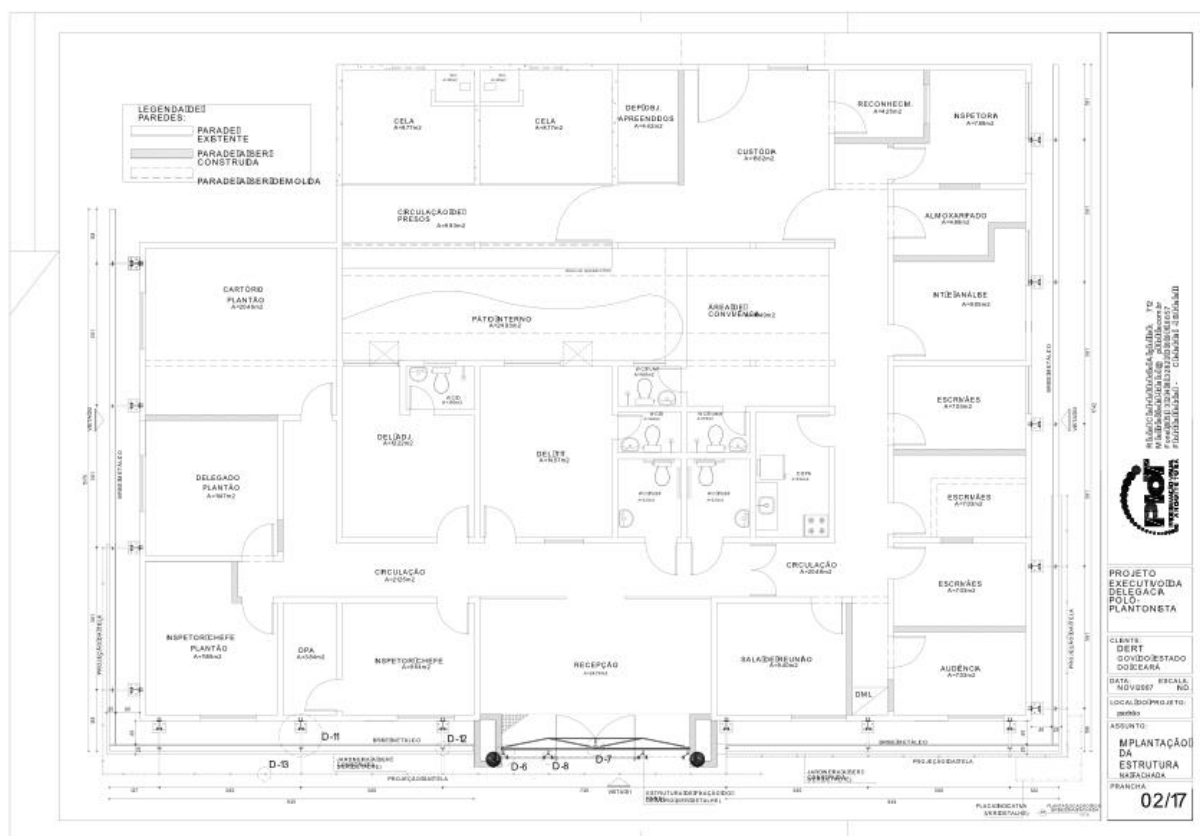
Implantação da Estrutura na Fachada: planta de localização dos brises na fachada.
